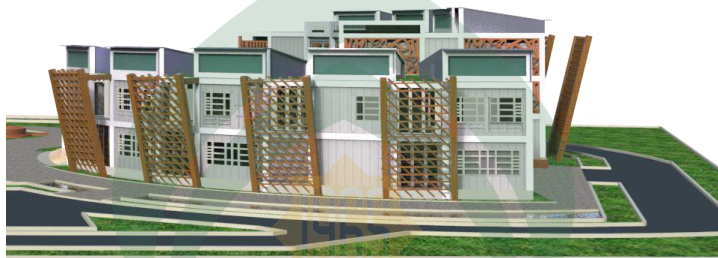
Tampilan Bangunan Pada Site Plan
